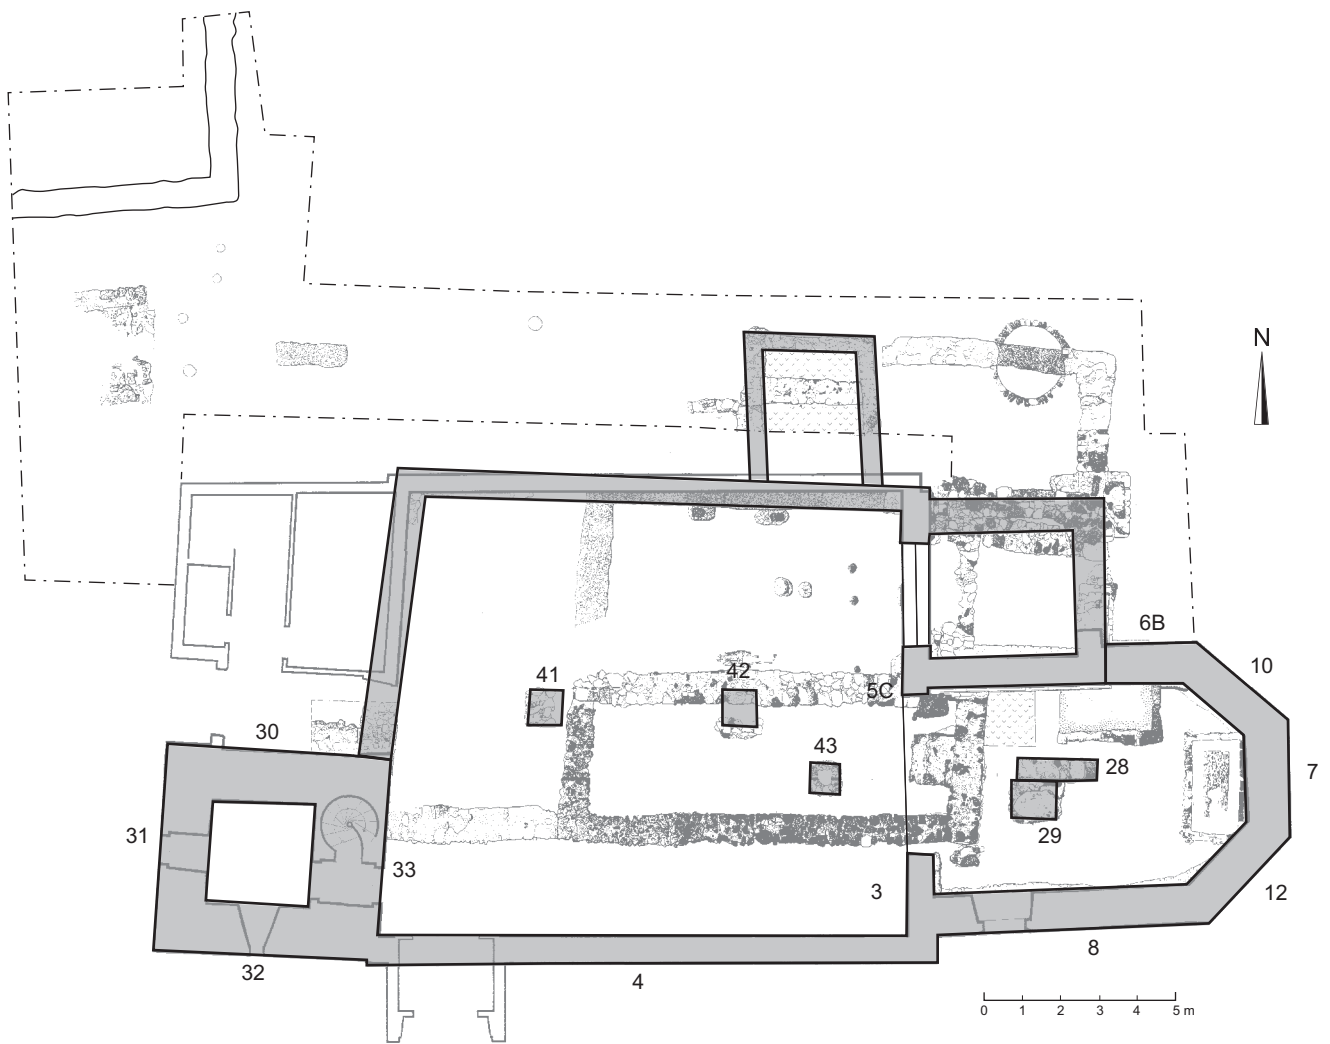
Winterthur-Veltheim. Grundriss der spätgotischen Kirche. M. 1:200.
